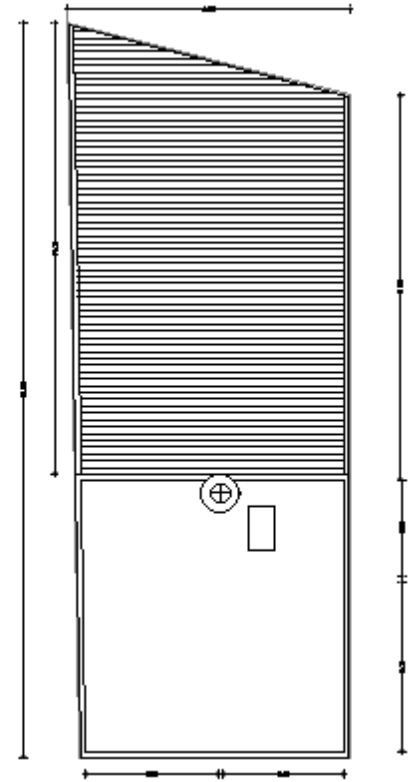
Planta azotea de proyecto arquitectónico de adecuación. Autoría propia.
